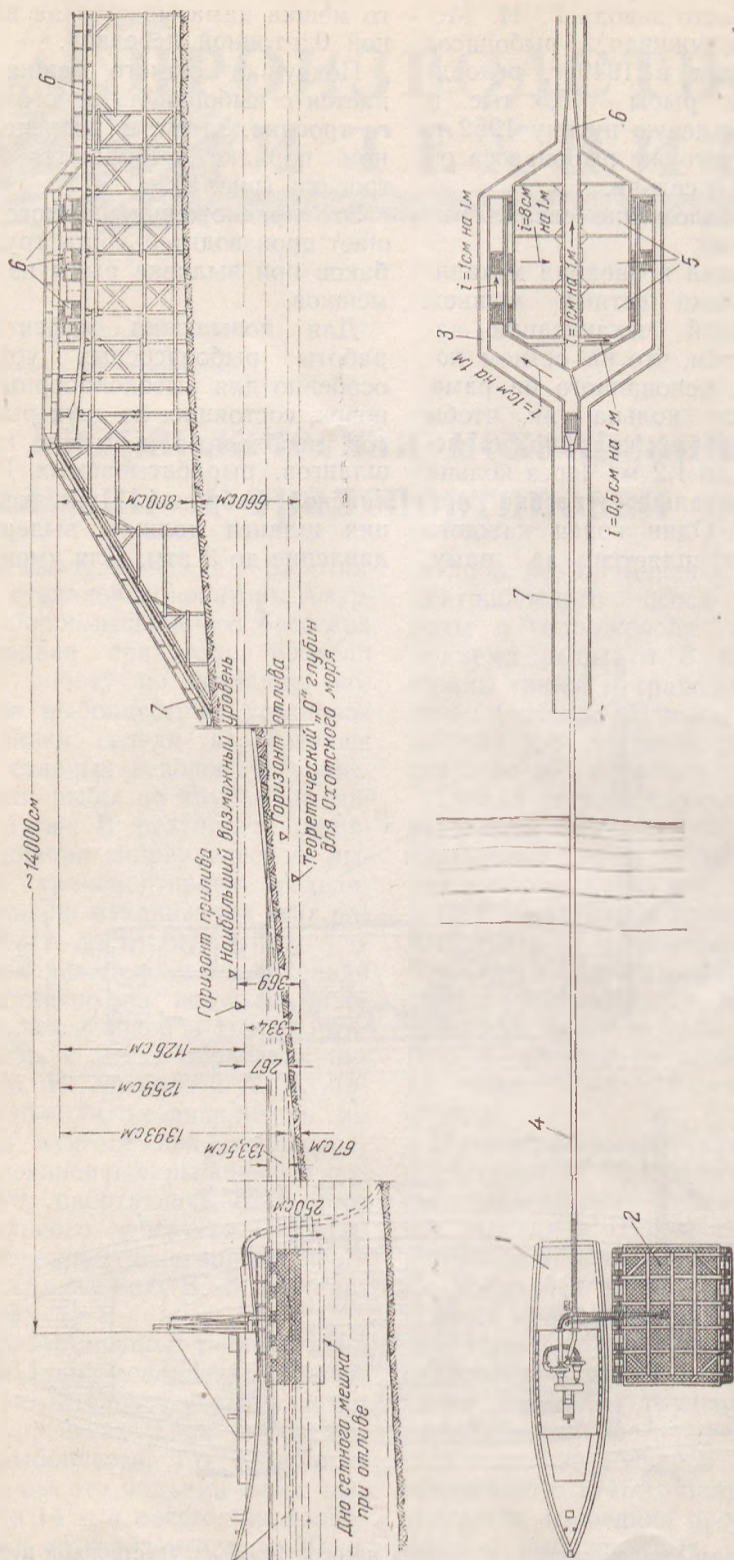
Схема выливки сельди из сетного мешка и транспортировки ее в цех обработки:
